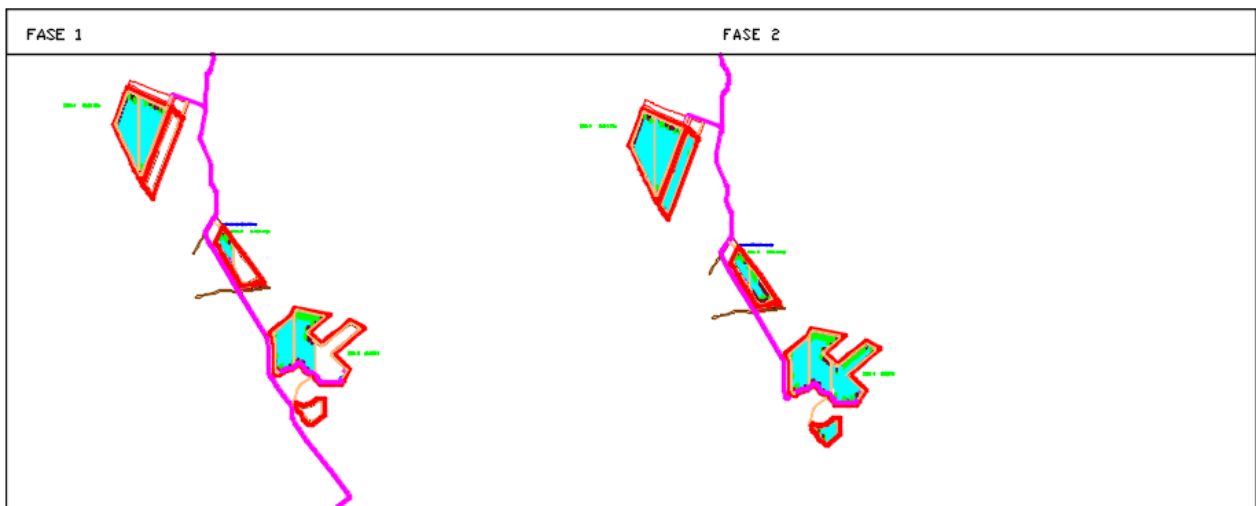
| Fasi di avanzamento lavori all'interno delle aree di impianto 4, 5 e 6
